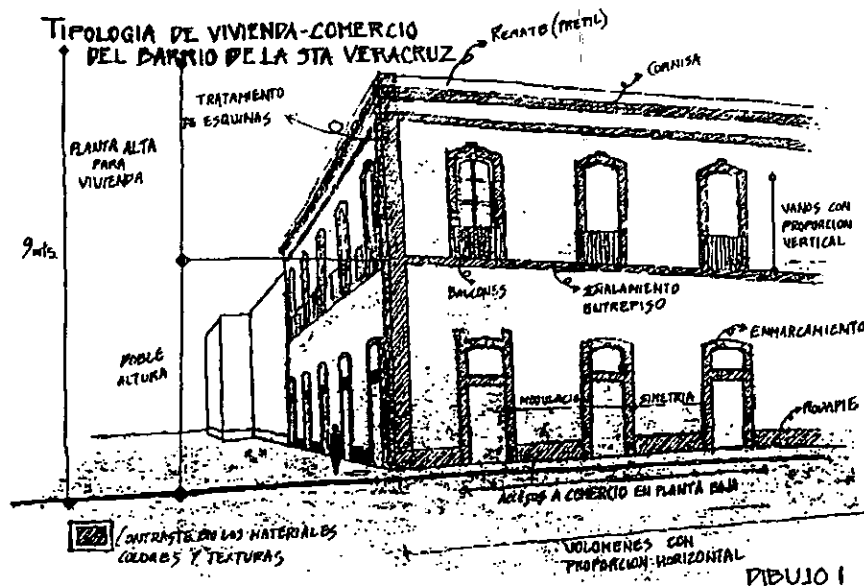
Dibujo en el cual se enumeran los elementos arquitectónicos mas utilizados en las construcciones del barrio.
